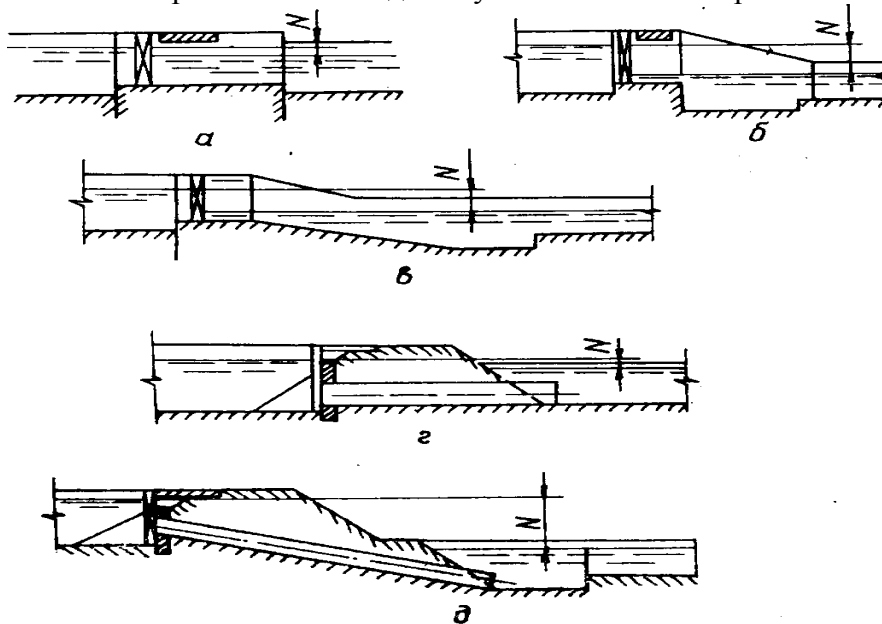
16. Схемы водовыпусков: а — открытый; б — открытый с перепадом; в — открытый с быстротоком; г — трубчатый; д — трубчатый, совмещенный с перепадом.
